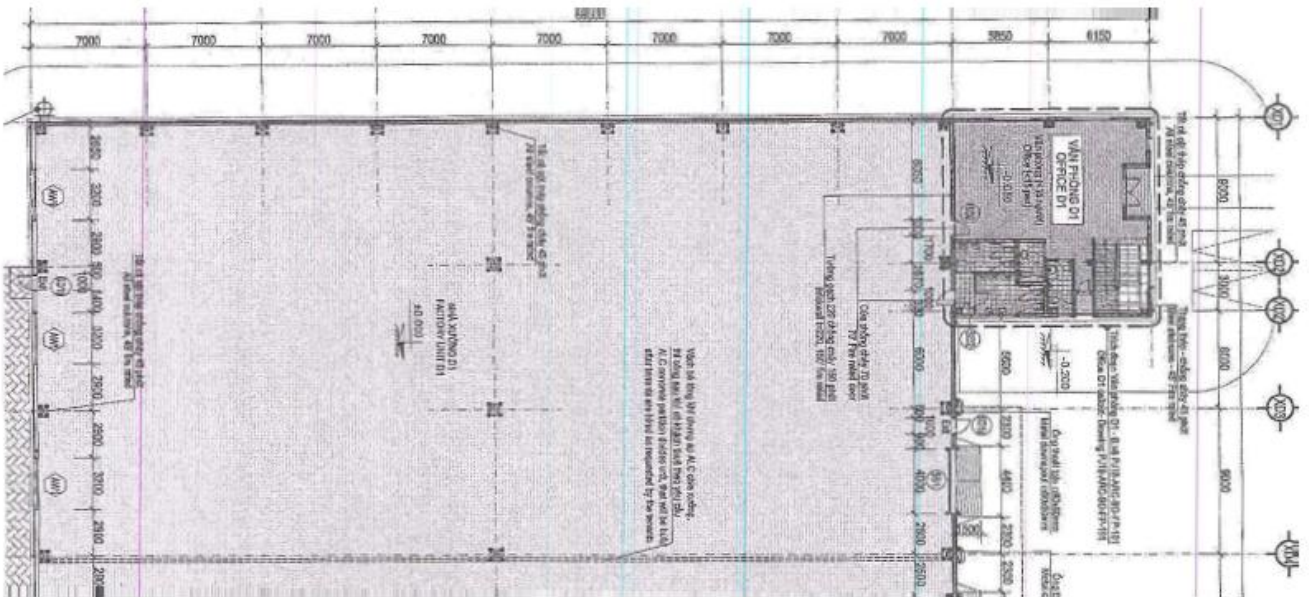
Tổng mặt bằng của dự án giai đoạn vận hành
